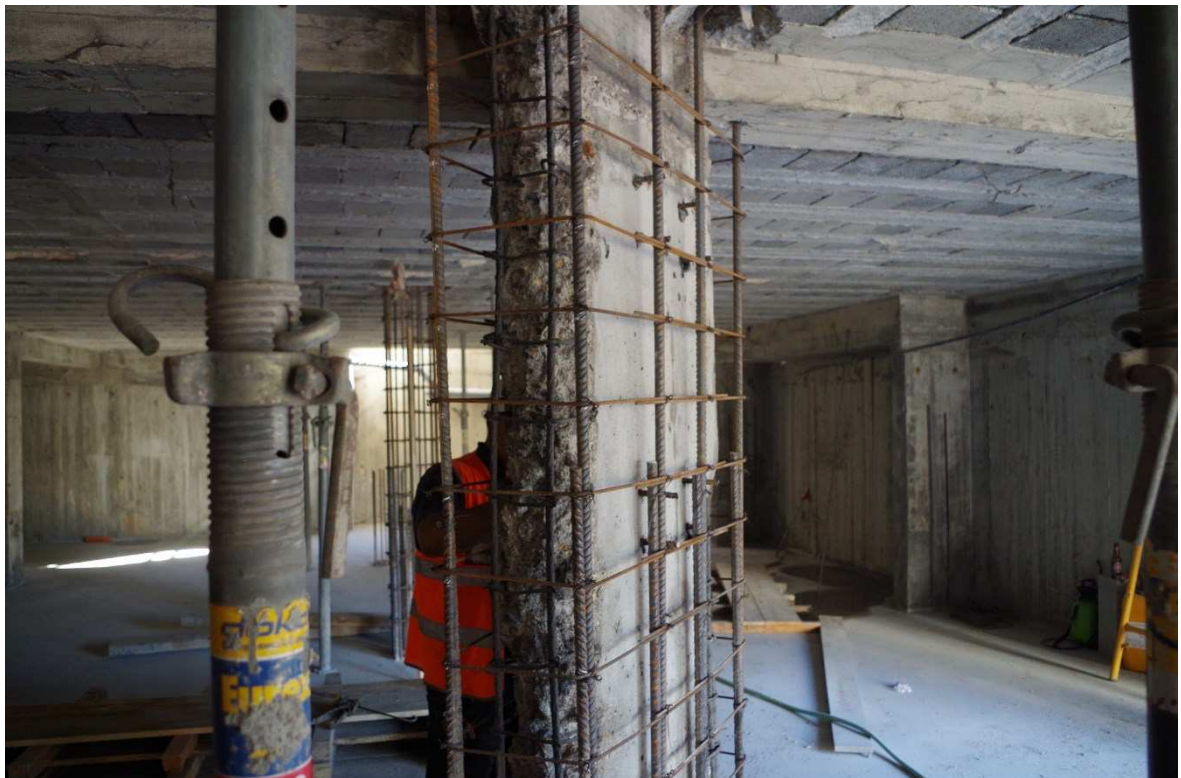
Reforço de Pilar existente com tratamento de armaduras executado
